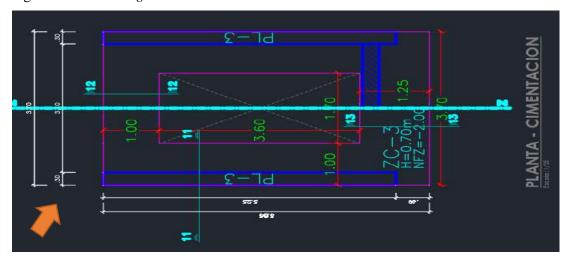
Documentación faltante respecto a detalles estructurales de columna CA-3.
